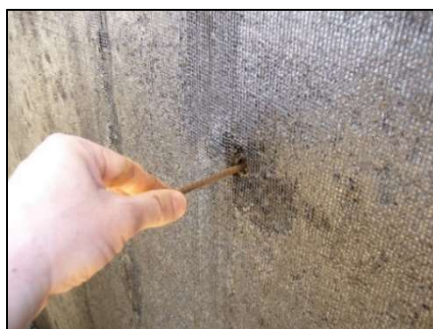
Vergalhão atravessando o furo para agulhas não tapado, para verificação do preenchimento do espaço vazio.
